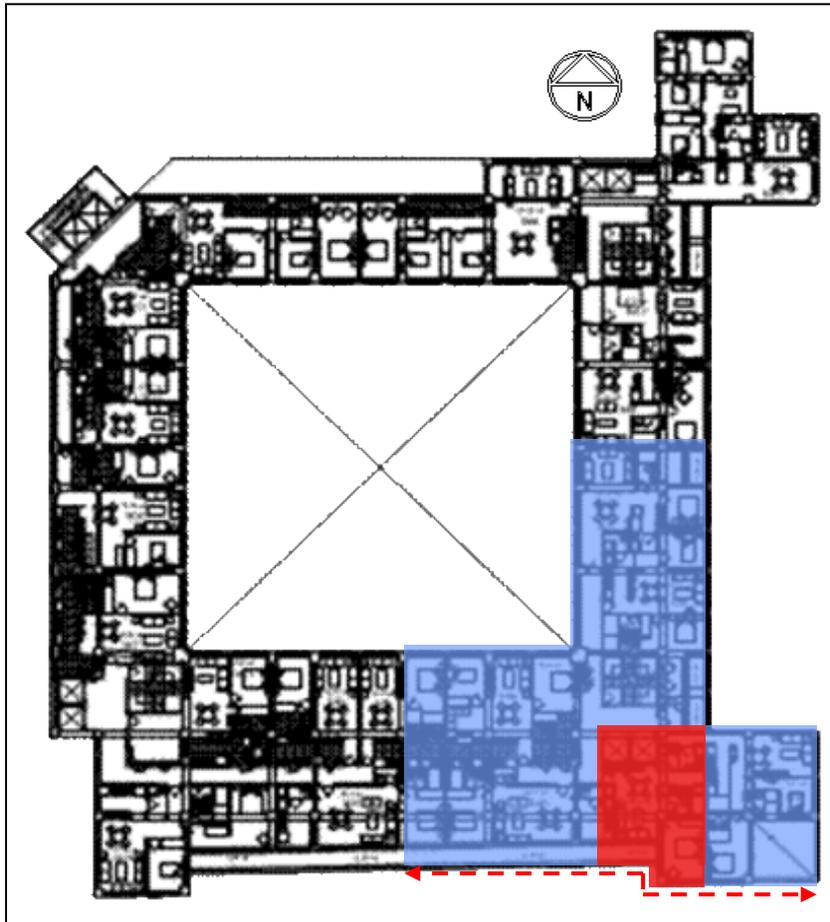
Croquis en planta del piso 14 de la fase tres del conjunto Puerta Alameda. © Desarrolladora Del Parque, 2007.
